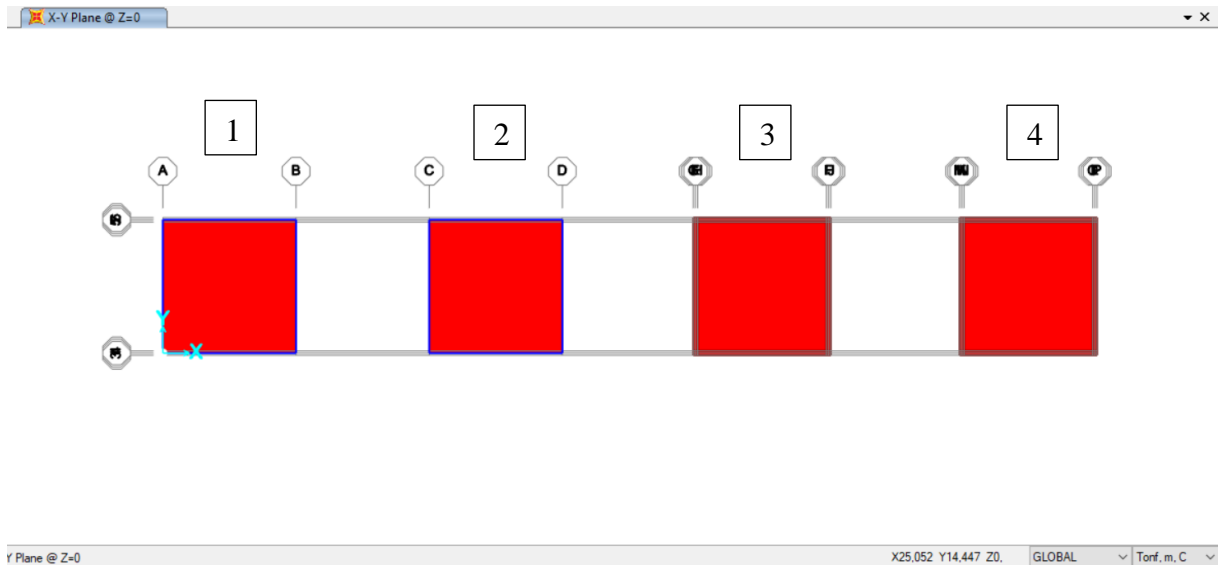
Os 4 modelos de vigas e lajes realizados no SAP2000.
